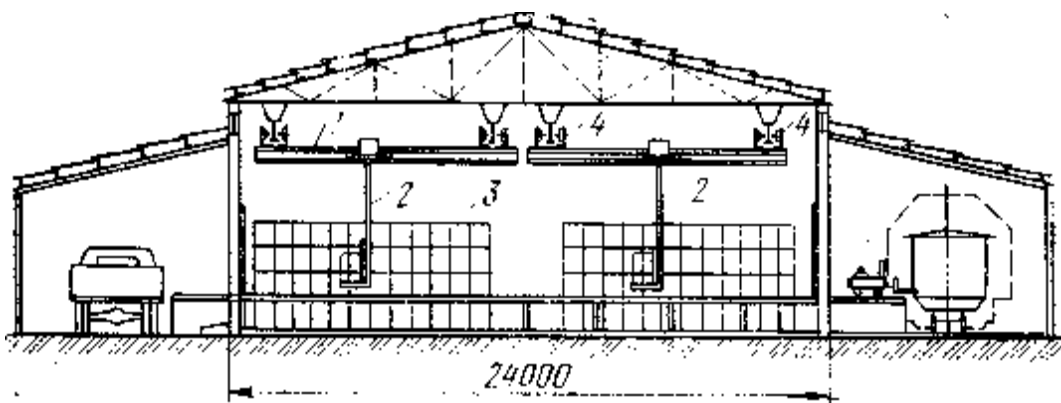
Схема автоматизованого складу з підвісним краном-штабелером (поперечний розріз): 1 - кран-балка; 2 - підвісний штабелер; 3 - вантаж у пакетах; 4 - візки на монорейках
